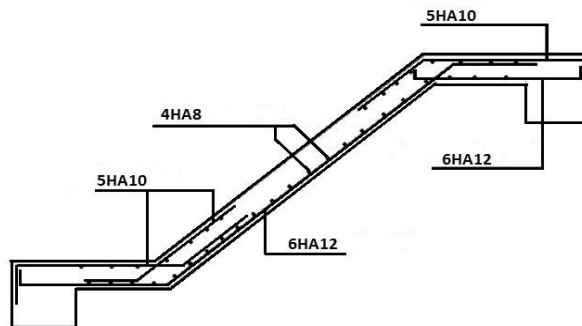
Schéma de ferrailage de la volée 1RDC1
